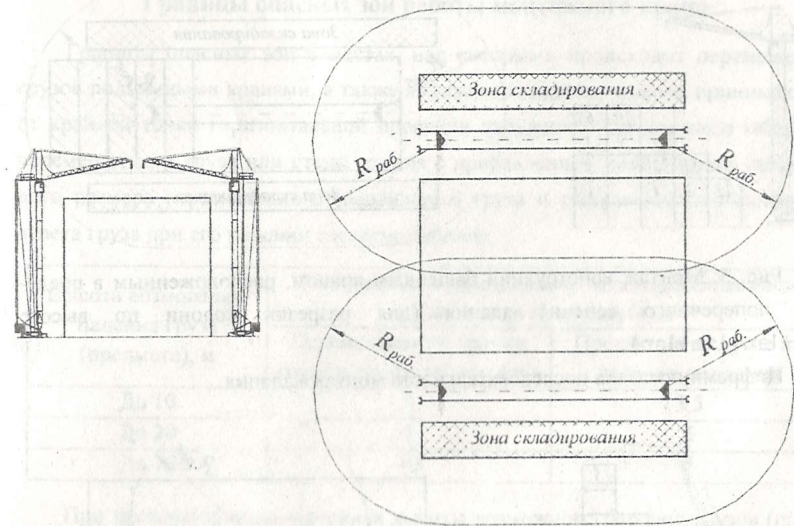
Монтаж железобетонных конструкций двумя башенными кранами
